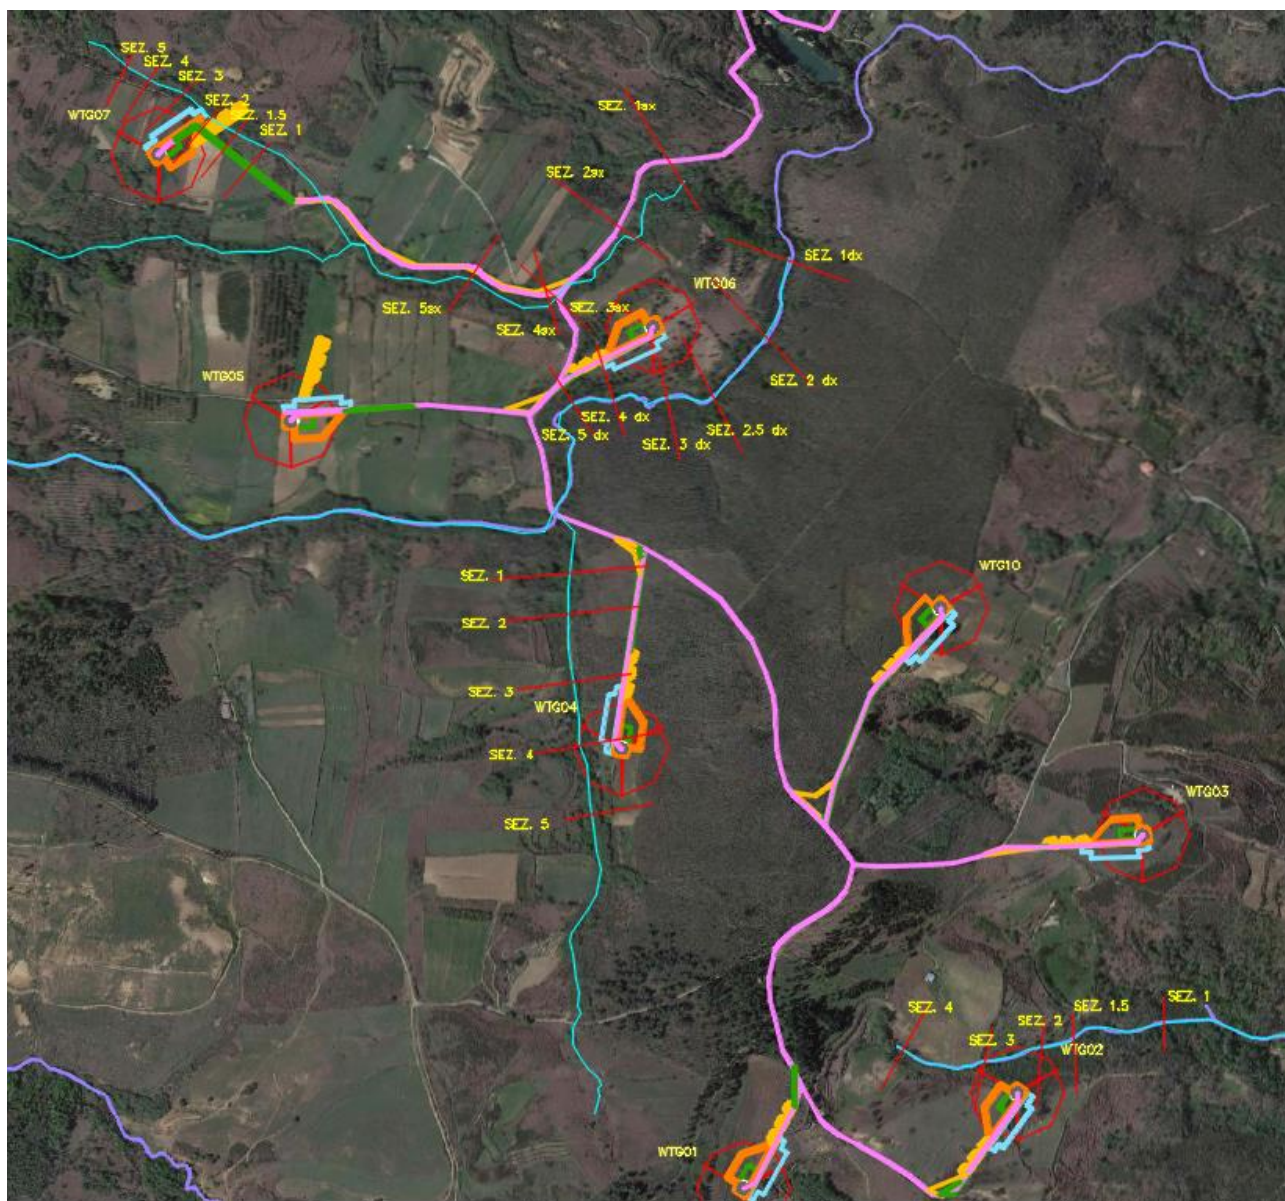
Planimetria con indicazione delle sezioni in dwg su base ortofoto.
